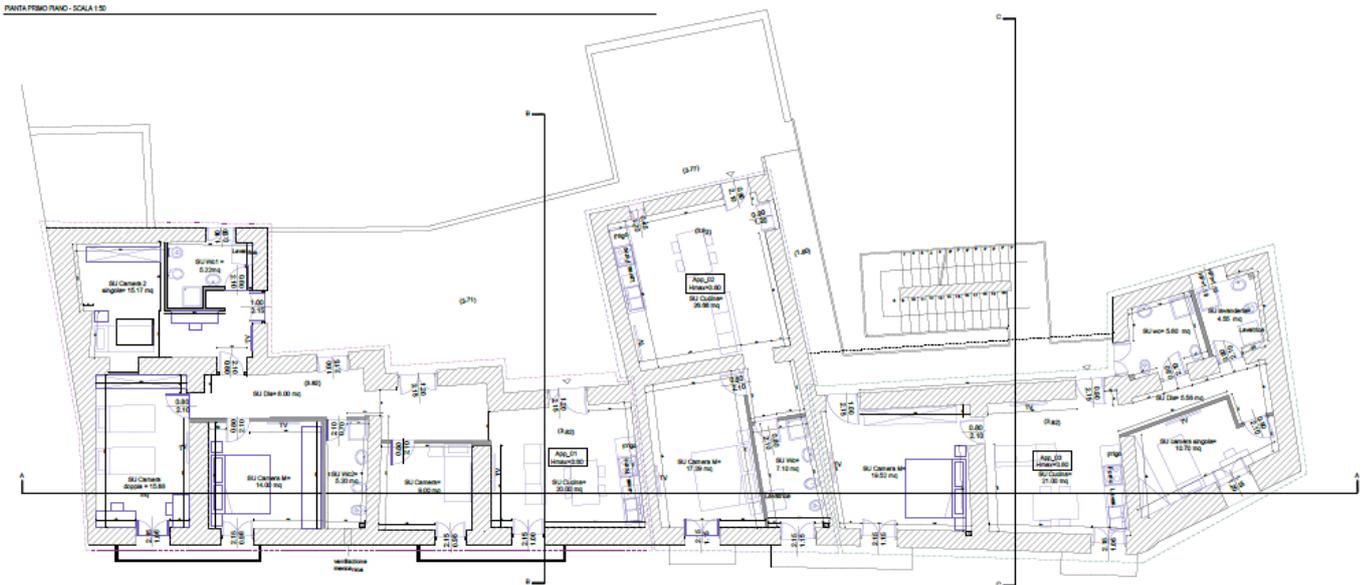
Progetto architettonico edifici D/E (pianta piano primo)
